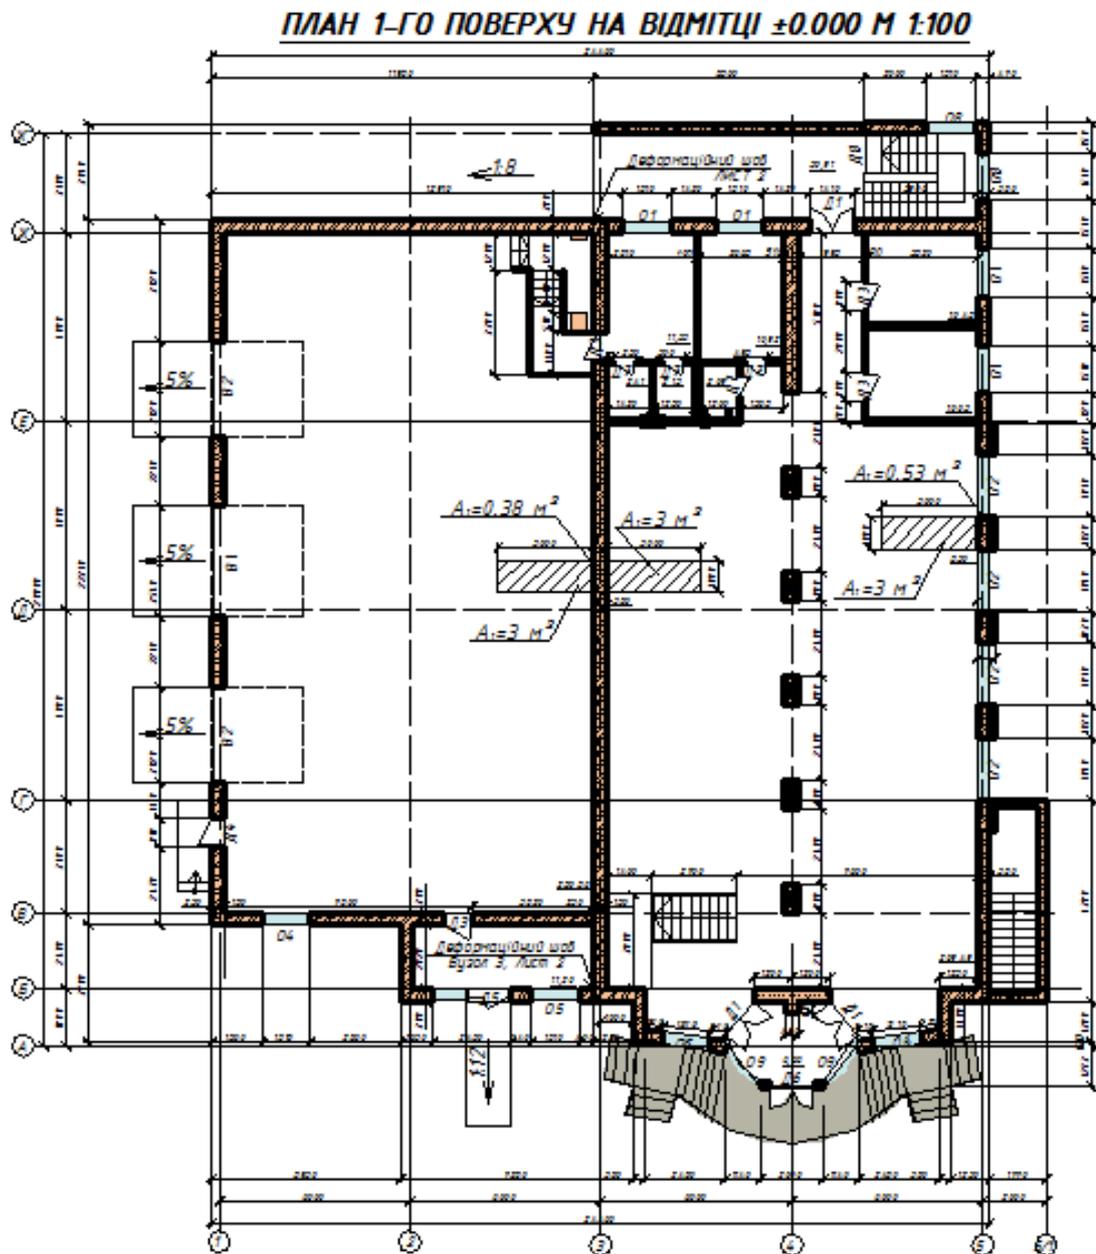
Схема планування 1-го поверху майбутнього будівництва
